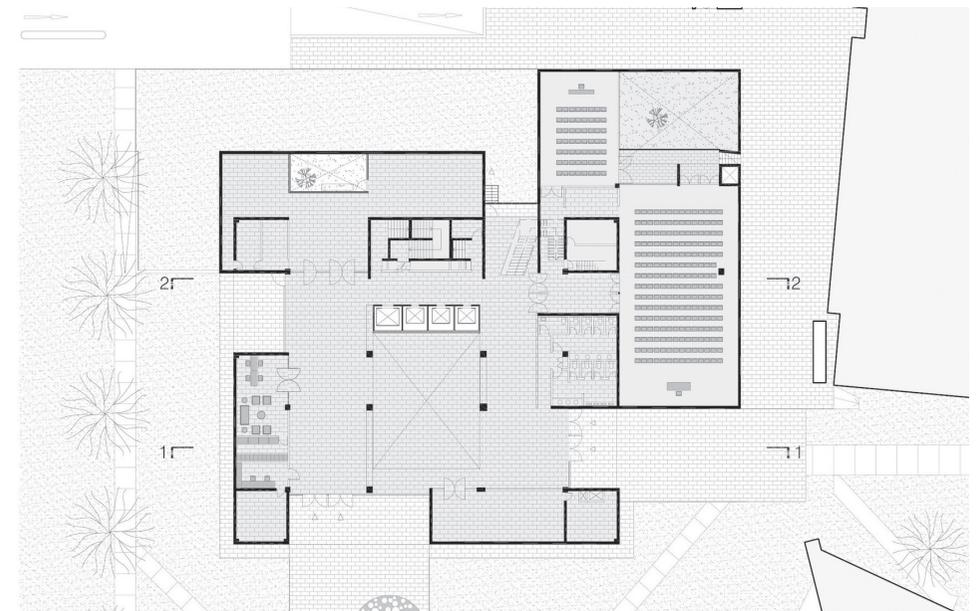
Planta térreo do Centro de Inovação Anacleto Angelini. Sem escala.
